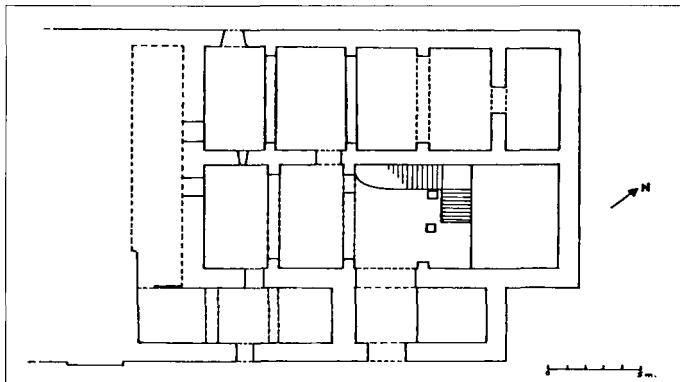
Planta baja del castillo-Palacio de La Zaida
